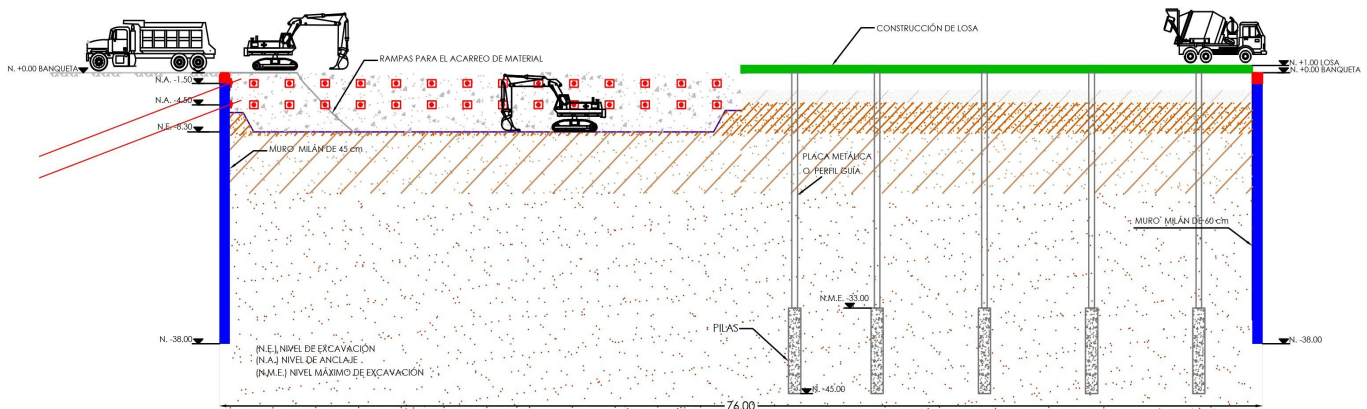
Excavación para ejecución del 2do nivel de anclaje y construcción de losa.
